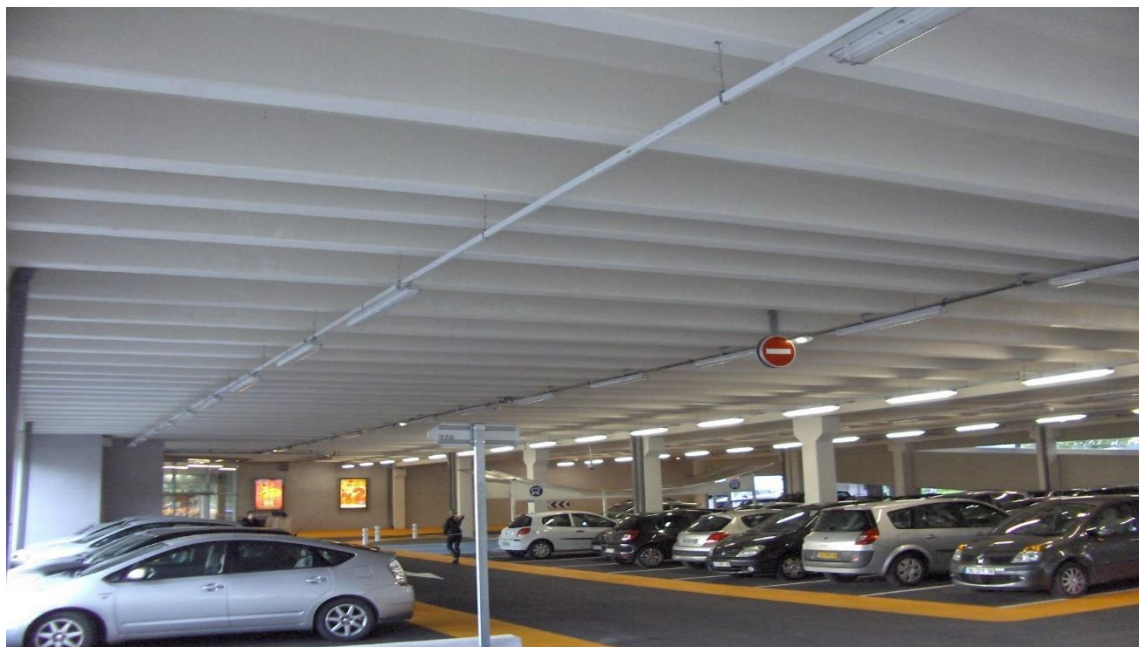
Plancher nervuré. (EUROBéton PBM.group, 2011)
